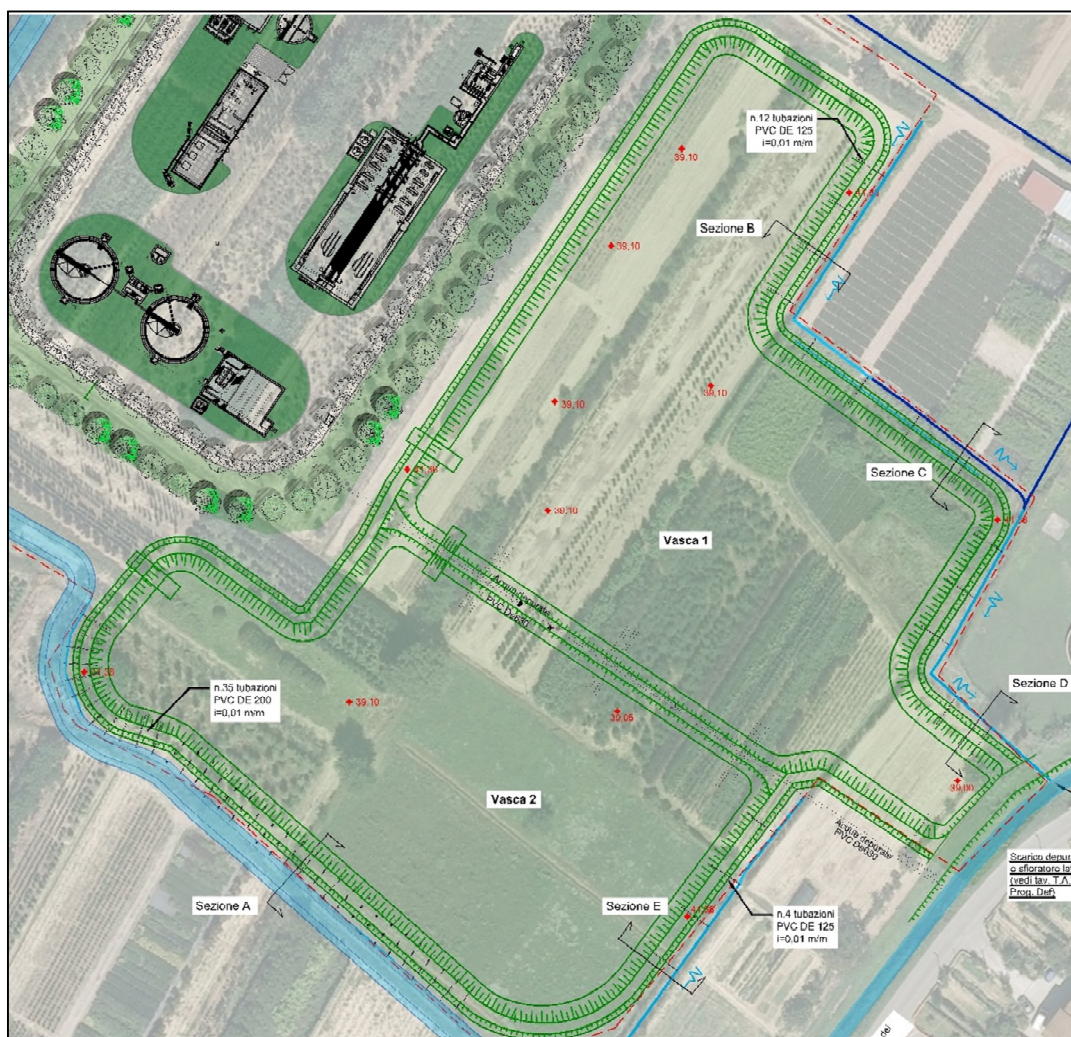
Estratto dell’elaborato T.A.M.1b - Opere riduzione rischio idraulico - Trasparenza idraulica allagamenti area - Prescrizioni CdS - Decreto AIT n.11/19
